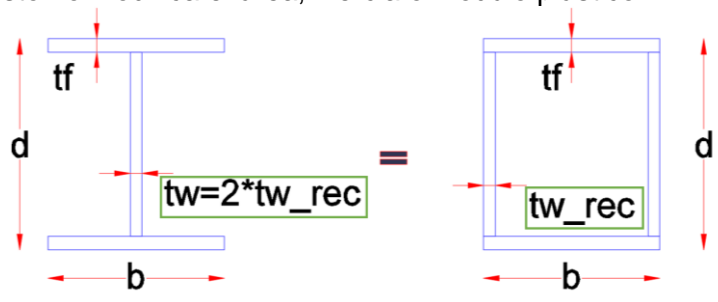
Secciones equivalentes para columnas tipo "I" y rectangular.
